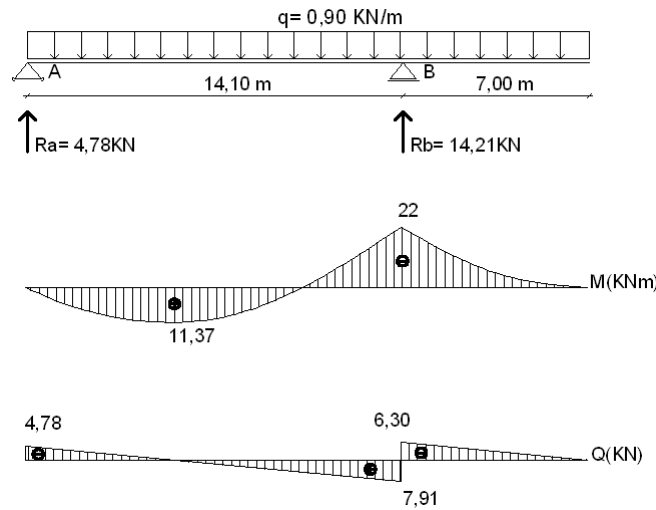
Esfuerzos característicos para un elemento estructural
